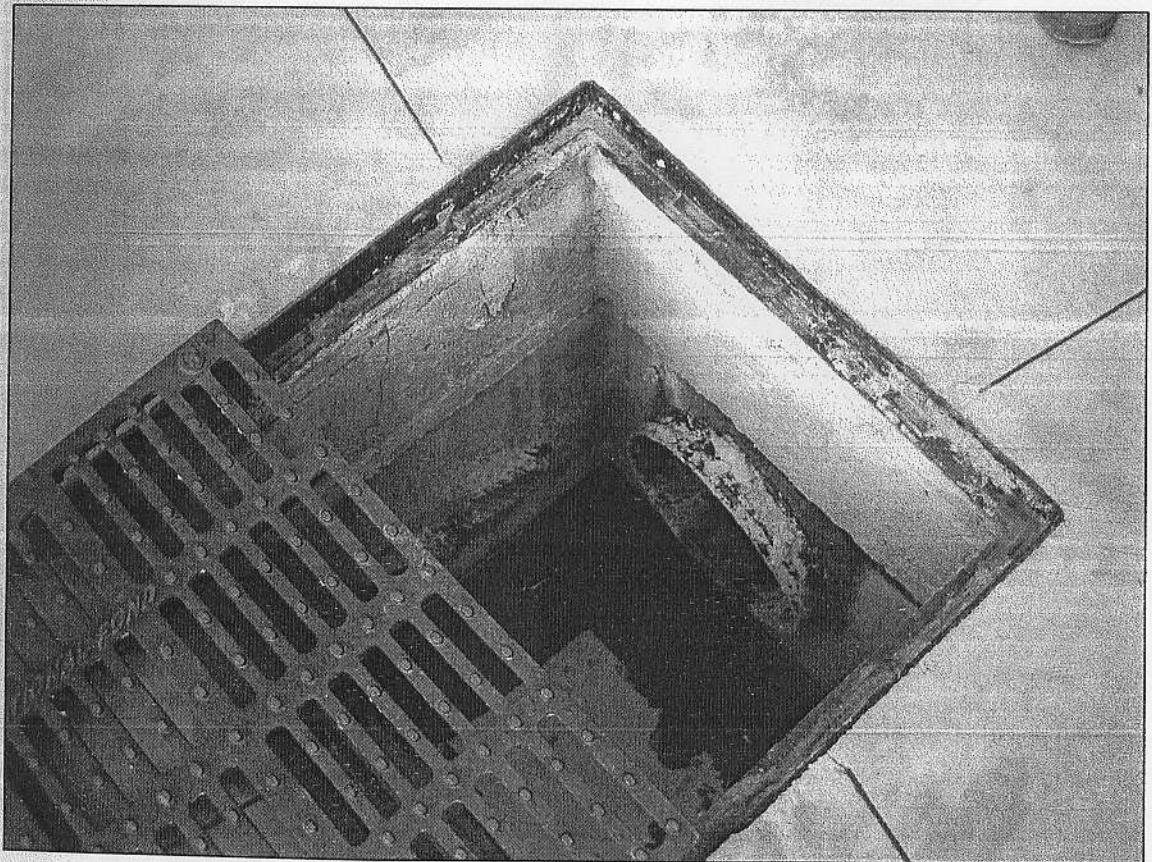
Vista interna della caditoia ripresa nella precedente foto n. 9
